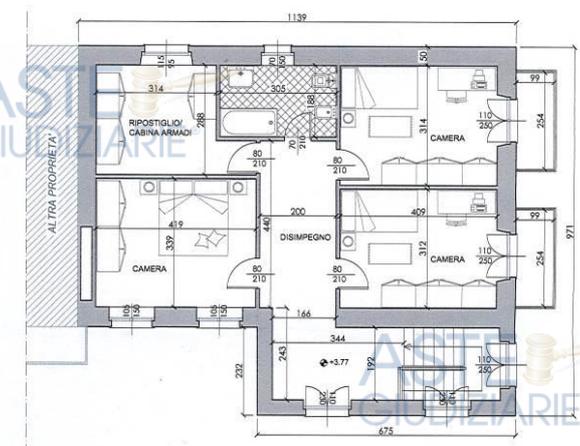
Estratto Dia n.77/49 del 2012 pianta piano primo
